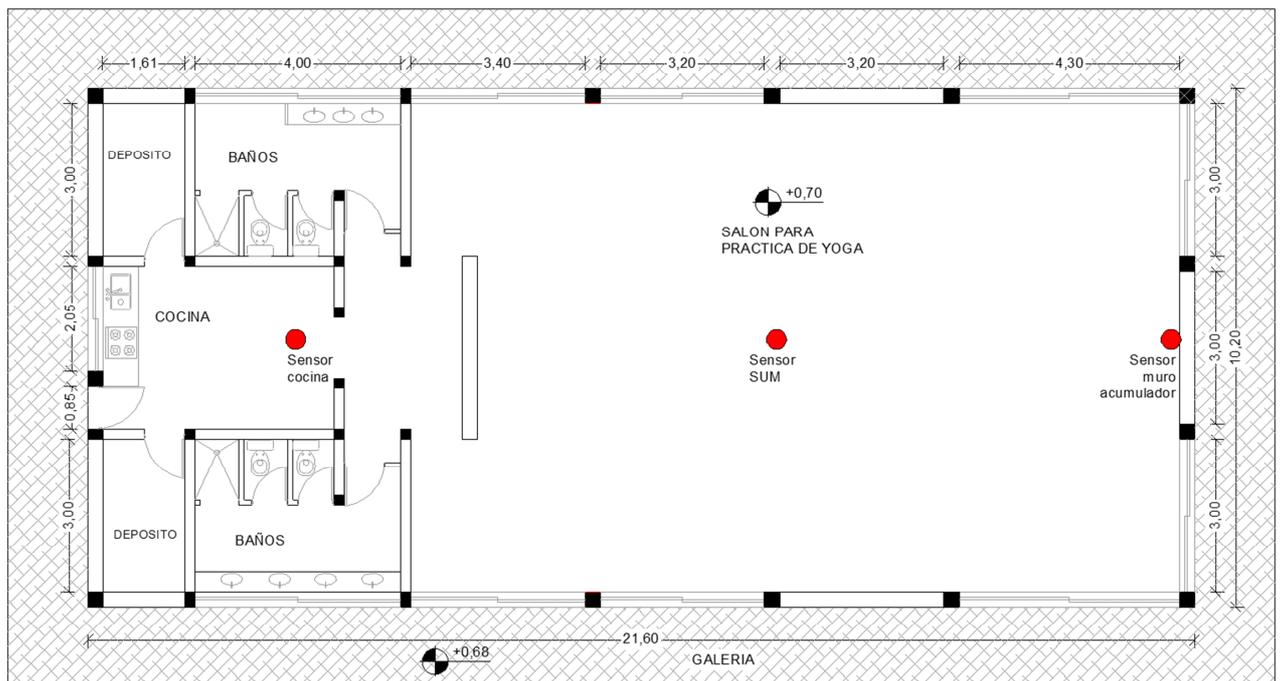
Plano de planta del salón de usos múltiples construido con quincha.
